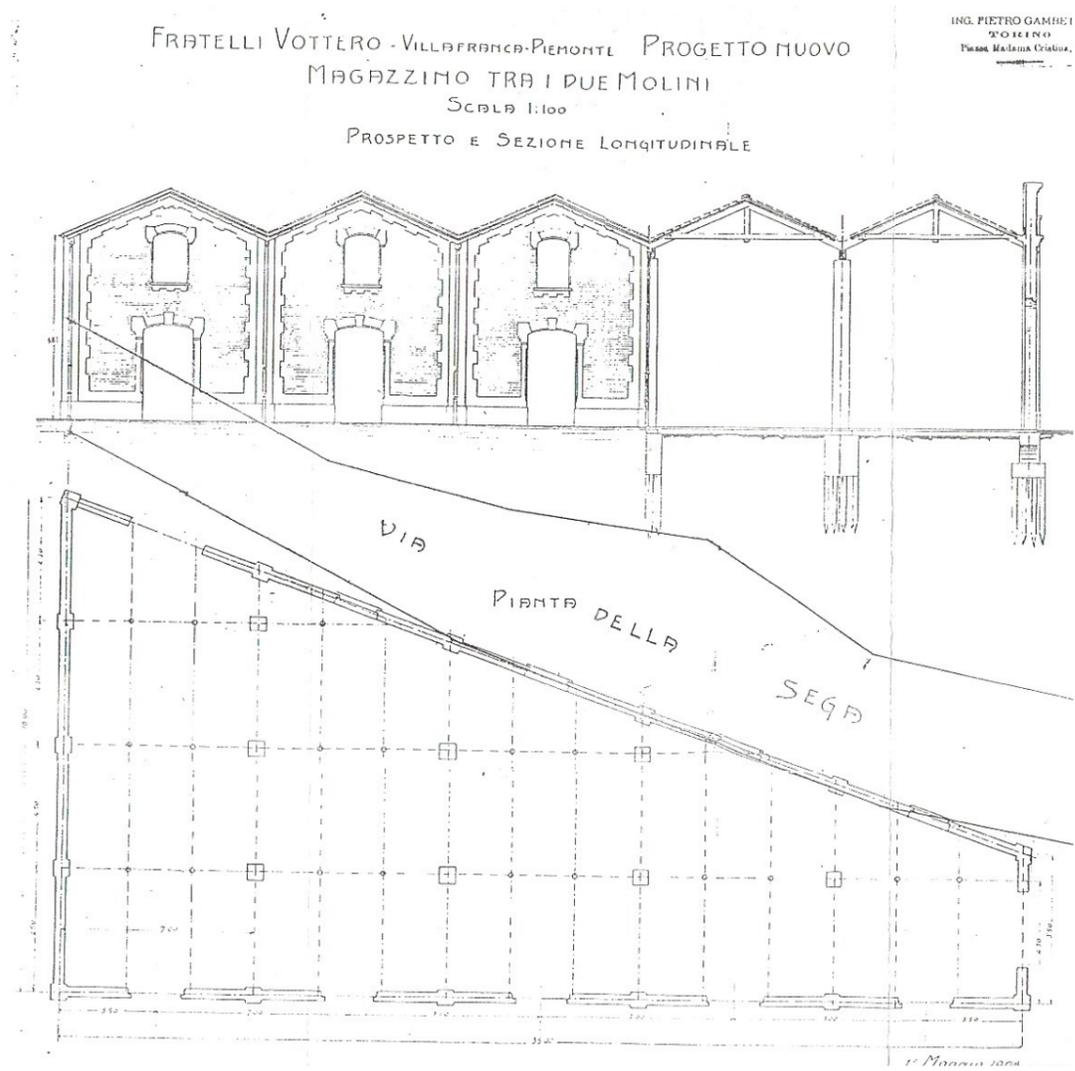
Il progetto originario dei magazzini nel 1908 - Ing. Pietro Gambetta
